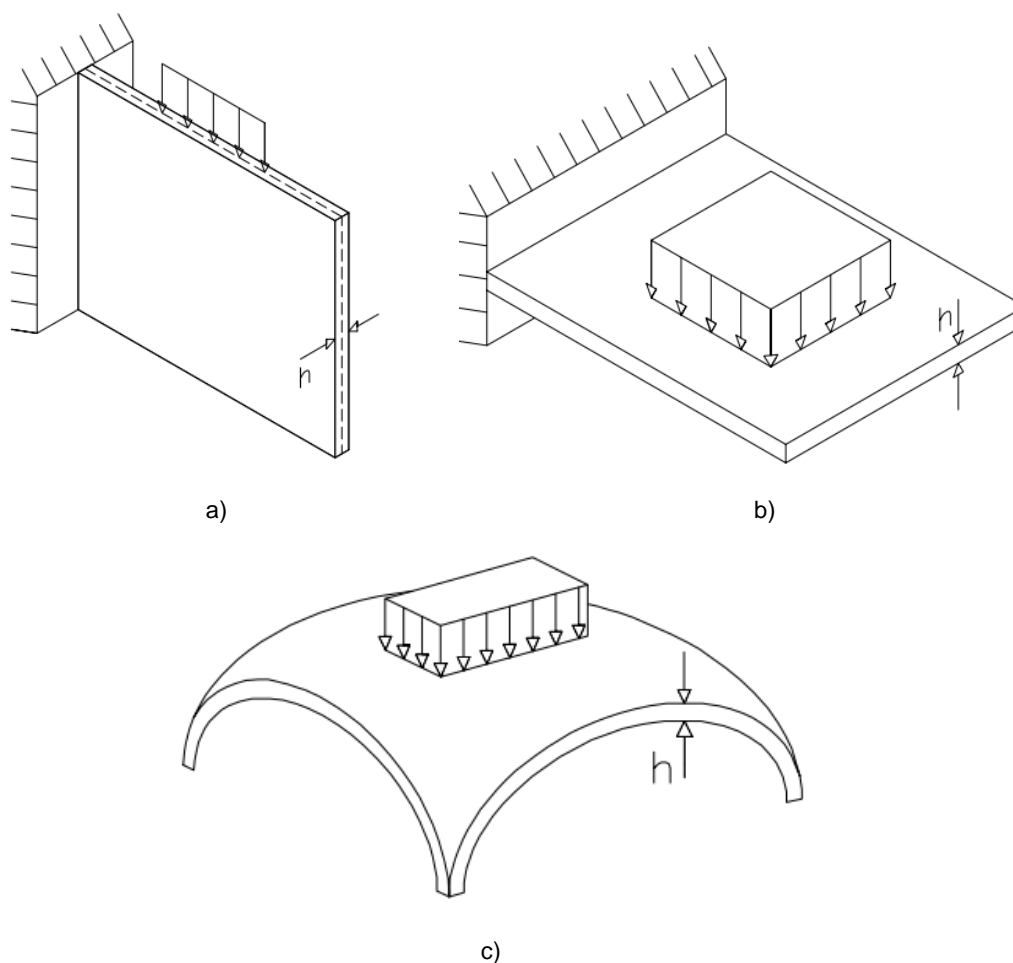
Tipos de estruturas laminares: a) elemento de membrana; b) elemento de laje; c) elemento de casca (Adaptado de Palácio, 2007).
